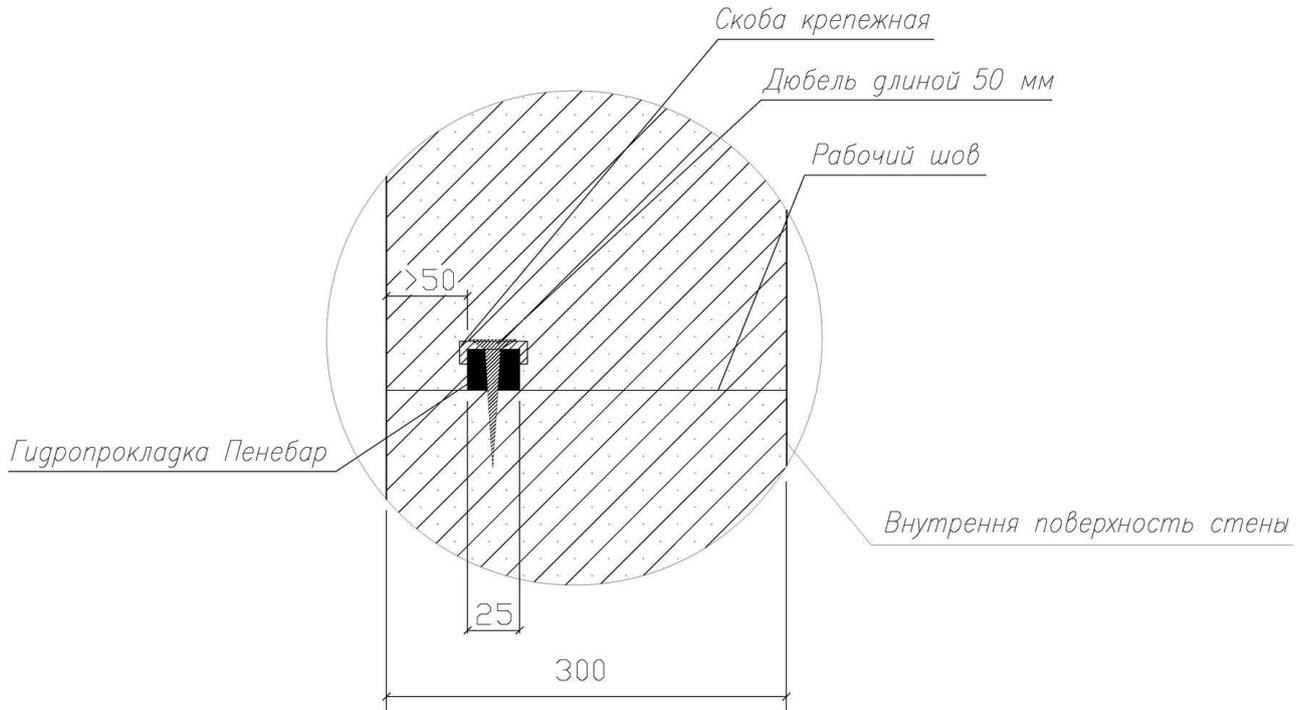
Схема установки гидропрокладки «Пенебар» в горизонтальных рабочих швах
